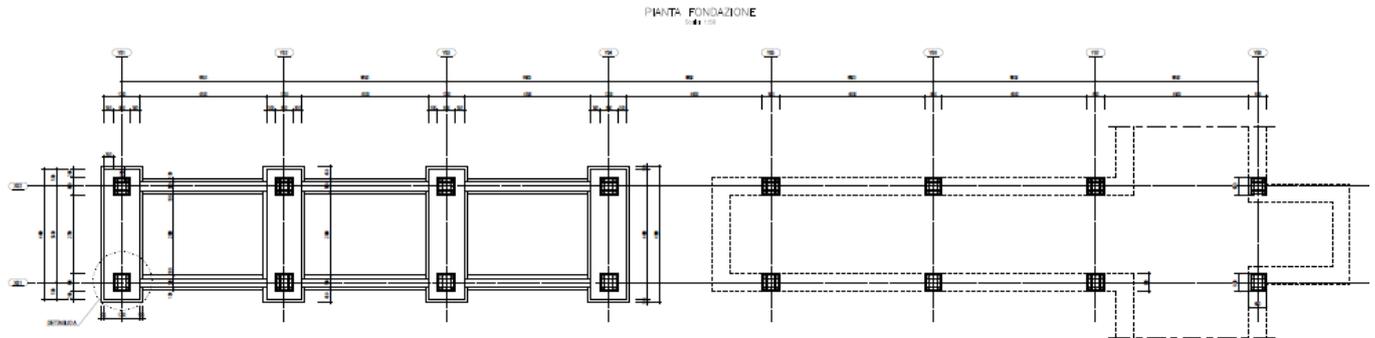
Pensiline – Pianta Fondazioni - Pensilina Nord
